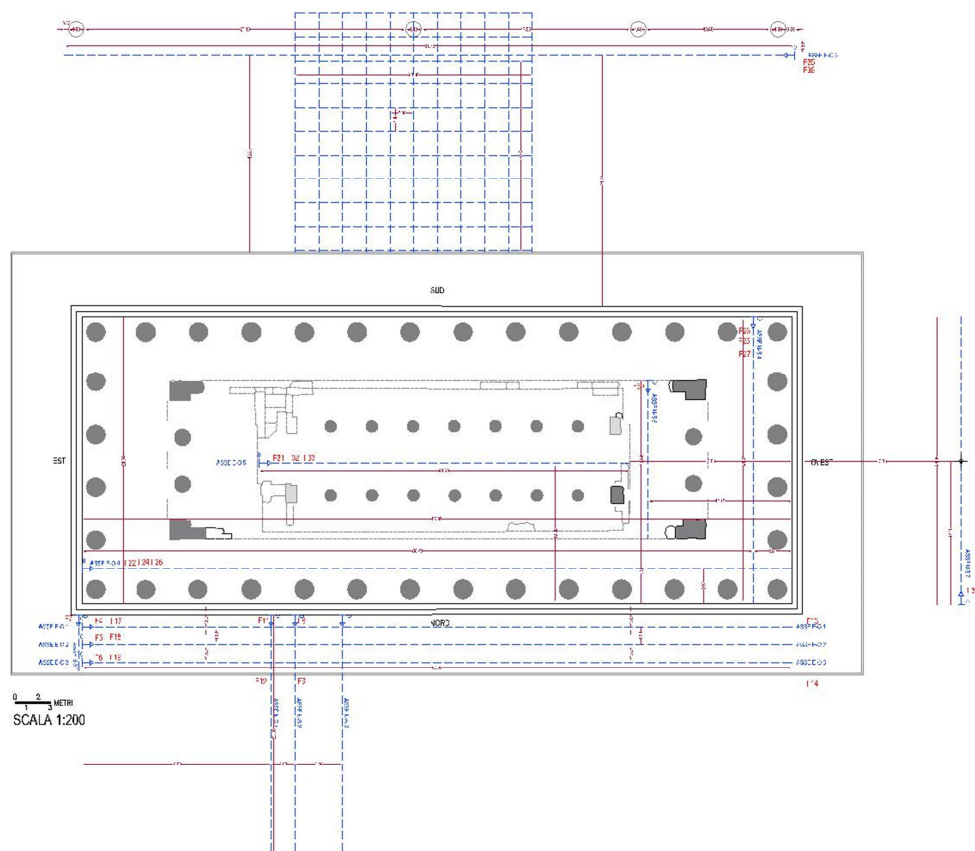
Planimetria illustrante i tracciati eseguiti.
